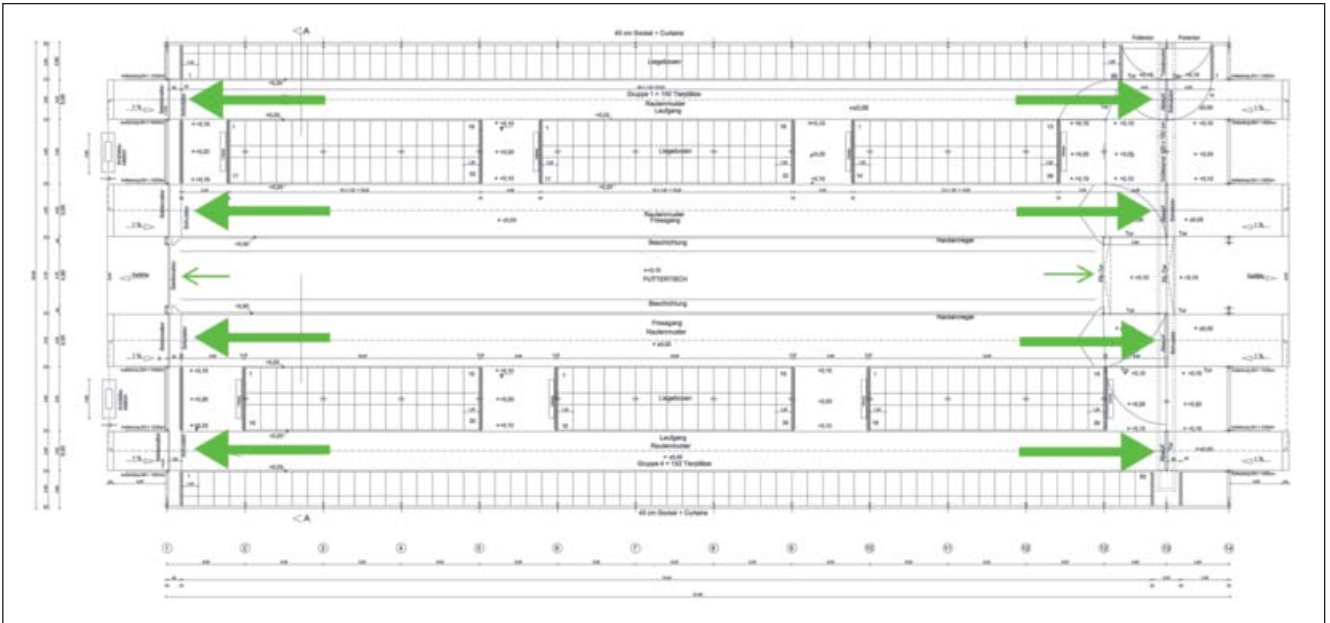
Exemplarischer Grundriss eines Milchviehstalles
